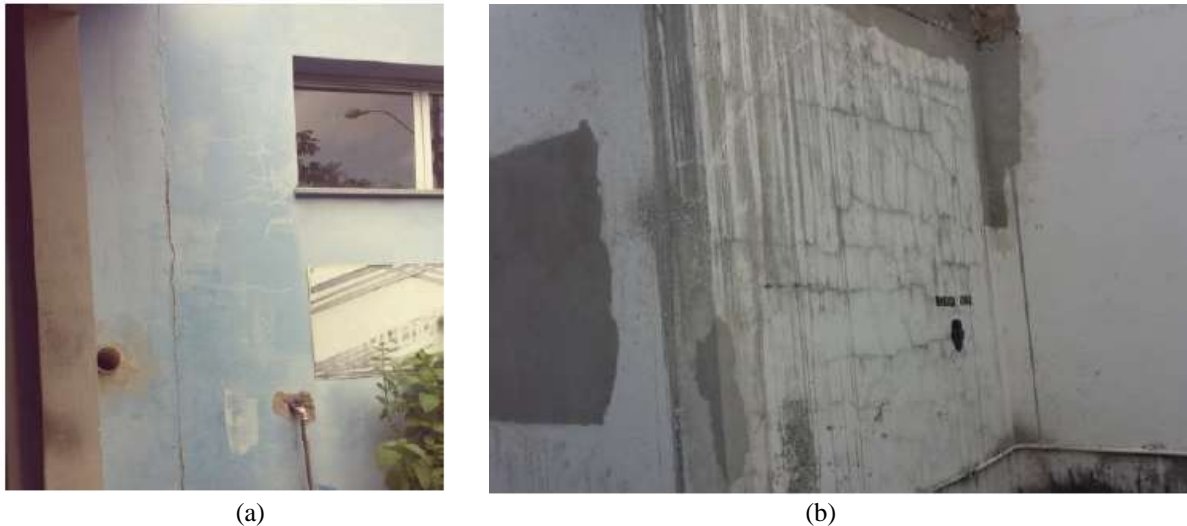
Mapeamento de fissuras - a) Fachada noroeste (principal), b) Parede externa na direção noroeste na área de cobertura.
